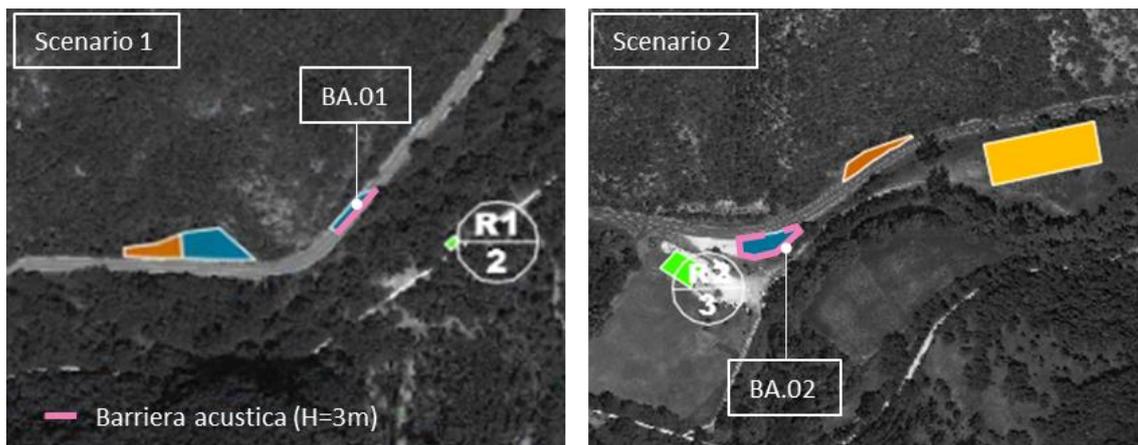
Localizzazione delle barriere acustiche di cantiere
